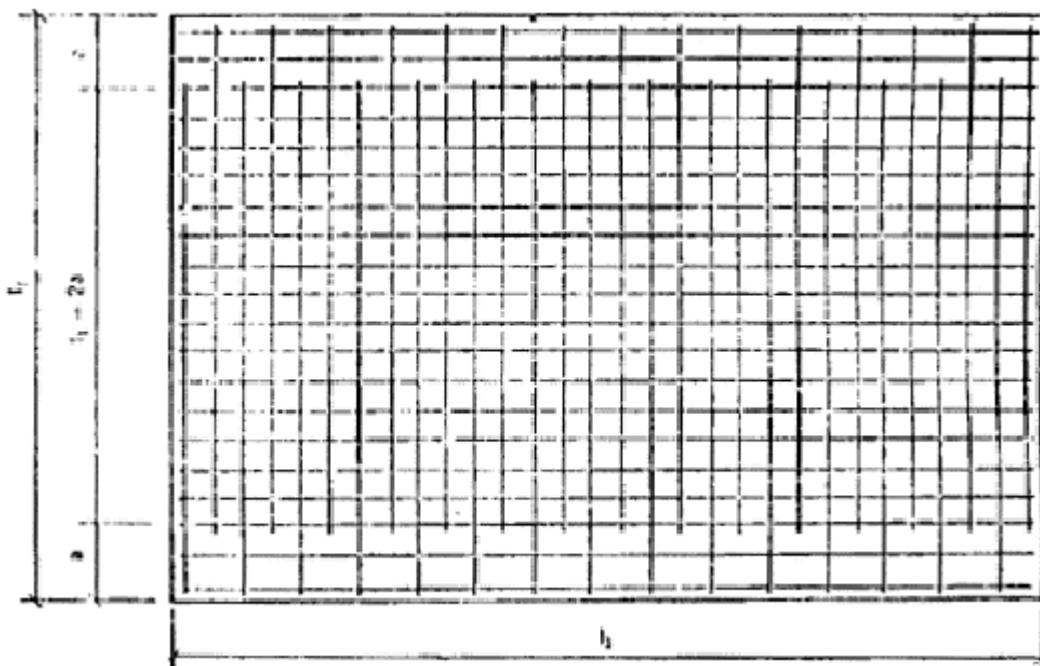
Схема к примеру расчета сборной плиты перекрытия, опертой по контуру
